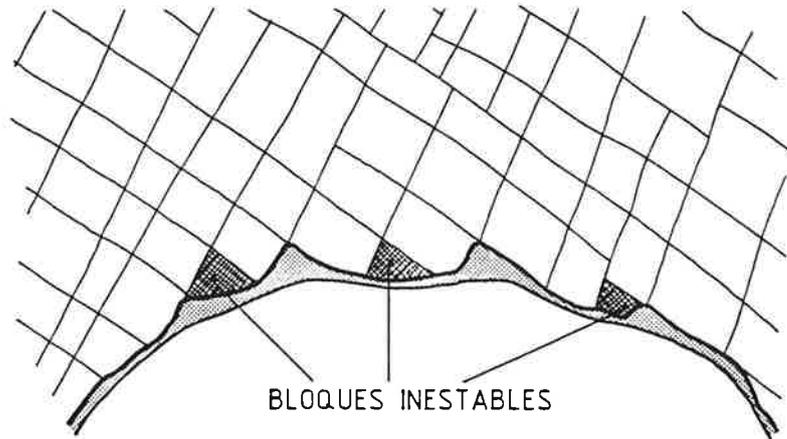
Refuerzo de la roca por medio de hormigón proyectado o fibra proyectada.
